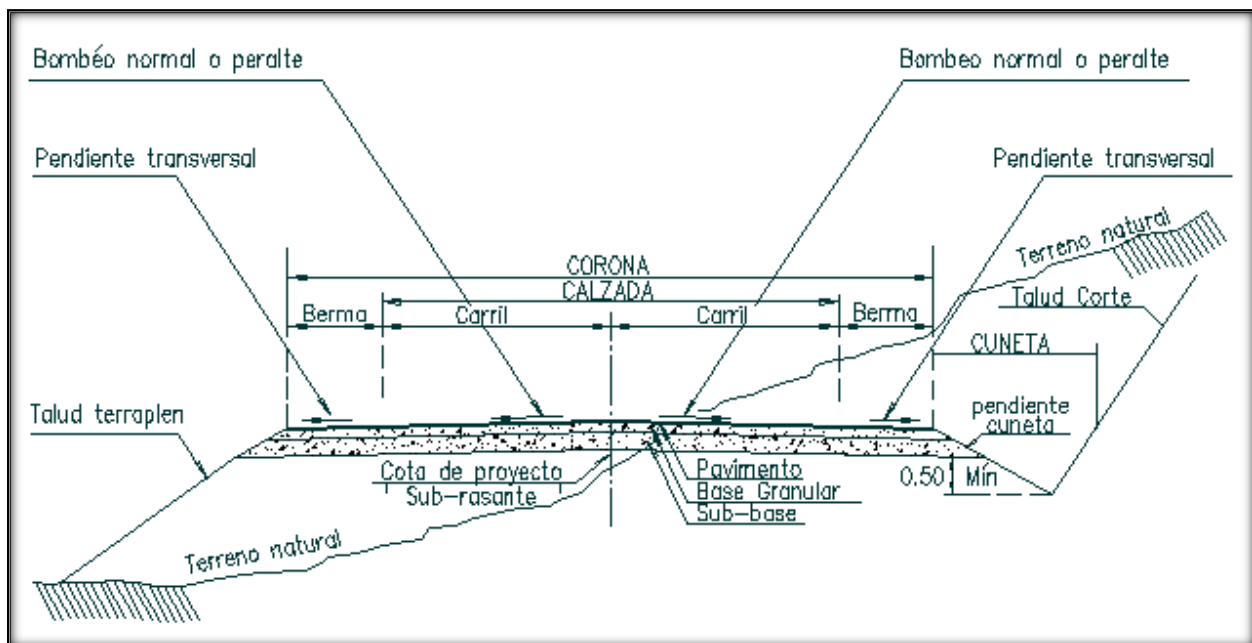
Sección transversal carretera. Fuente: SCT, Subsecretaría de Infraestructura.
